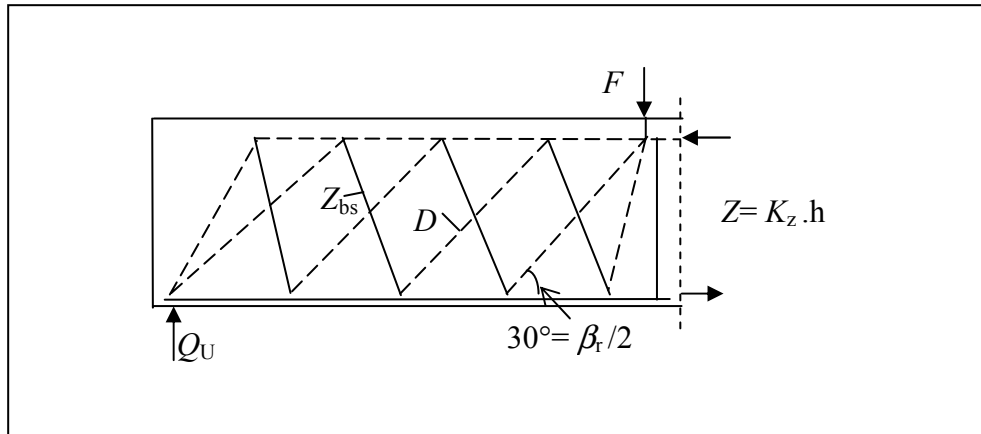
Fachwerkmodell mit parallelen Gurten [77]
